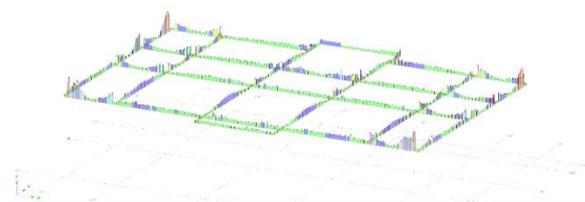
Расположение ригелей и максимальная площадь армирование на нижней грани ригелей с первого по пятые этажи пяти этажного каркасного железобетонного здания с внутренними и наружными стенами из газобетона.
